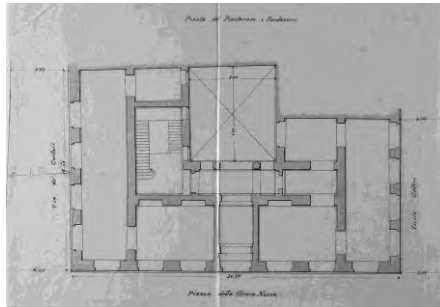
palazzo Trocchi pianta del pianterreno e delle fondazioni
